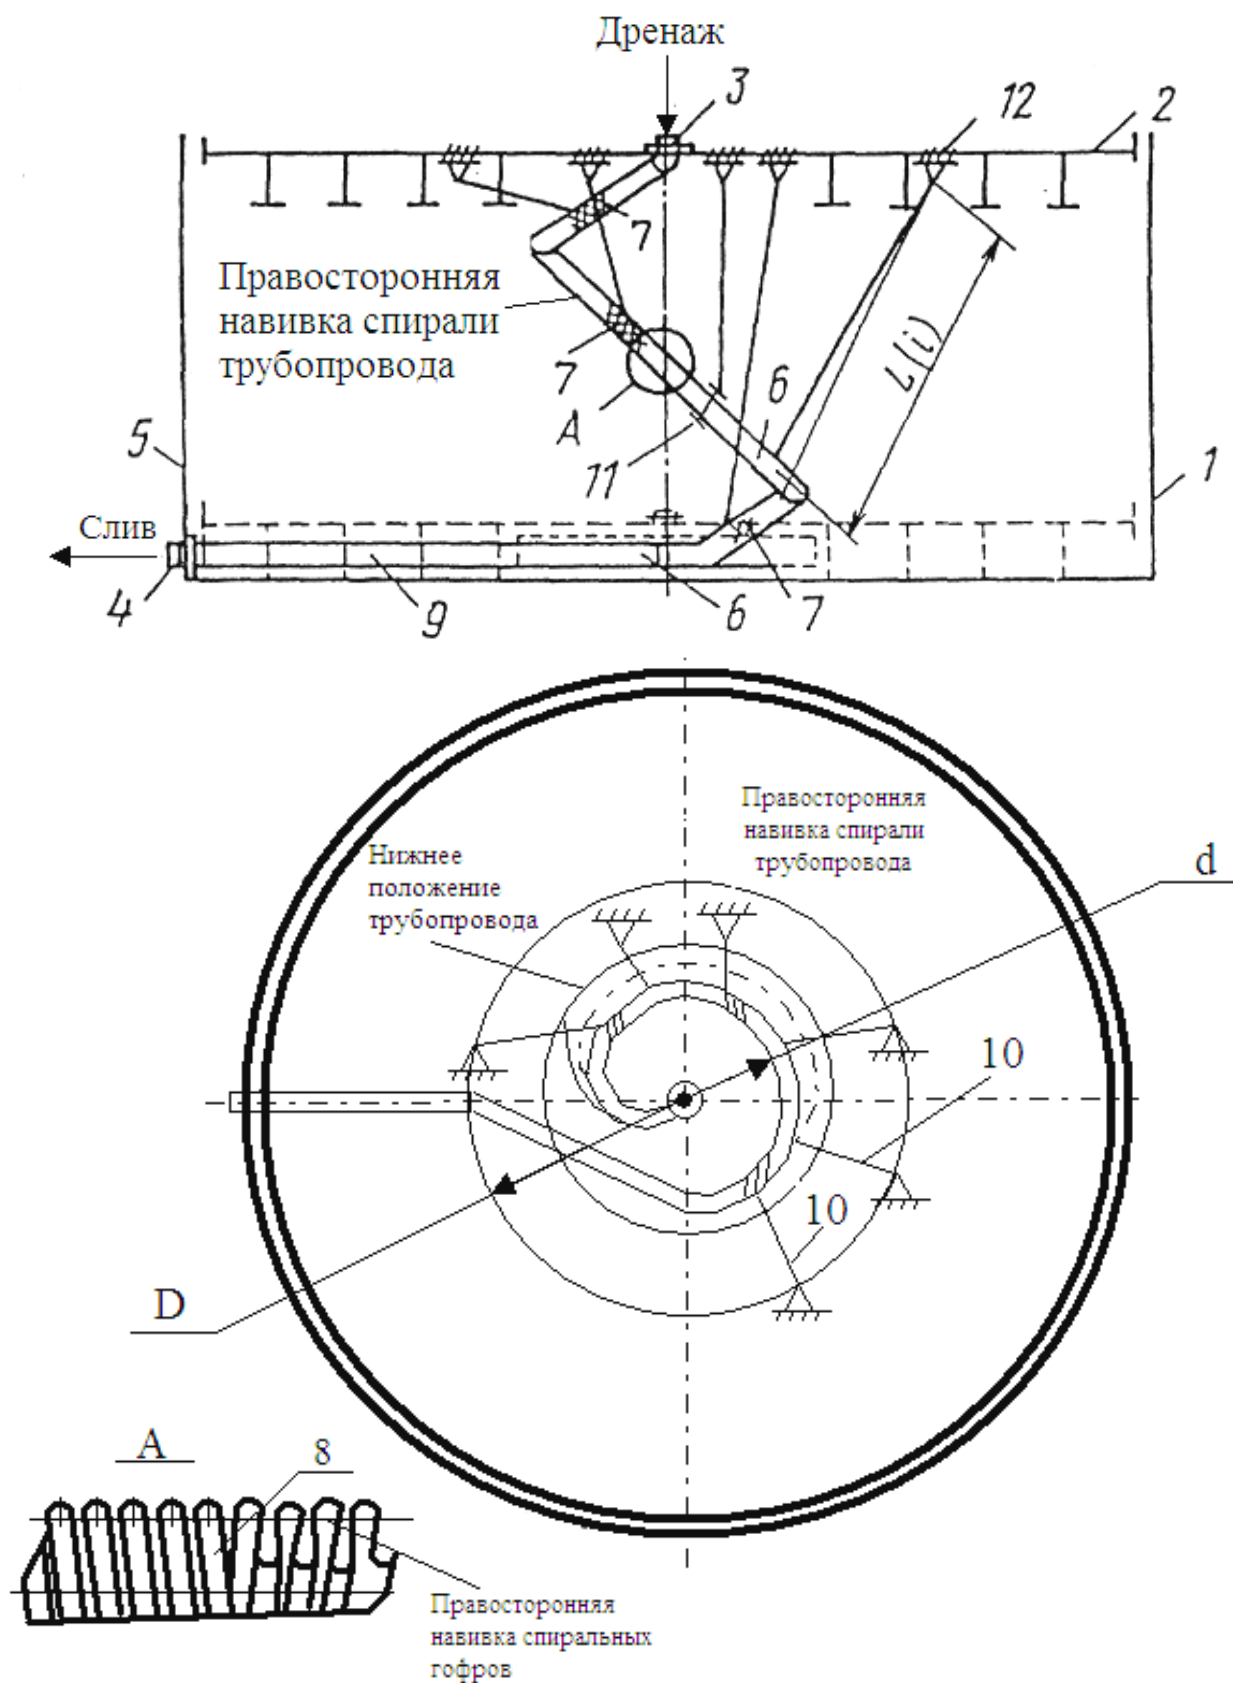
Конструкция водоспуска резервуара с плавающей крышей
